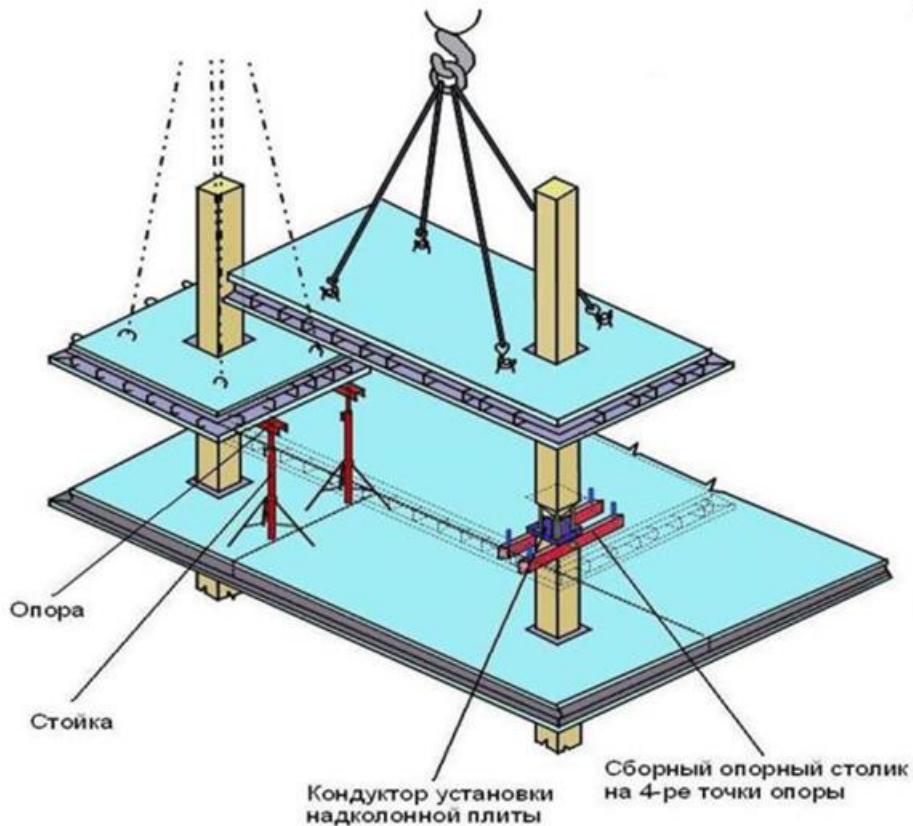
Установка одномодульных и двухмодульных плит перекрытия
